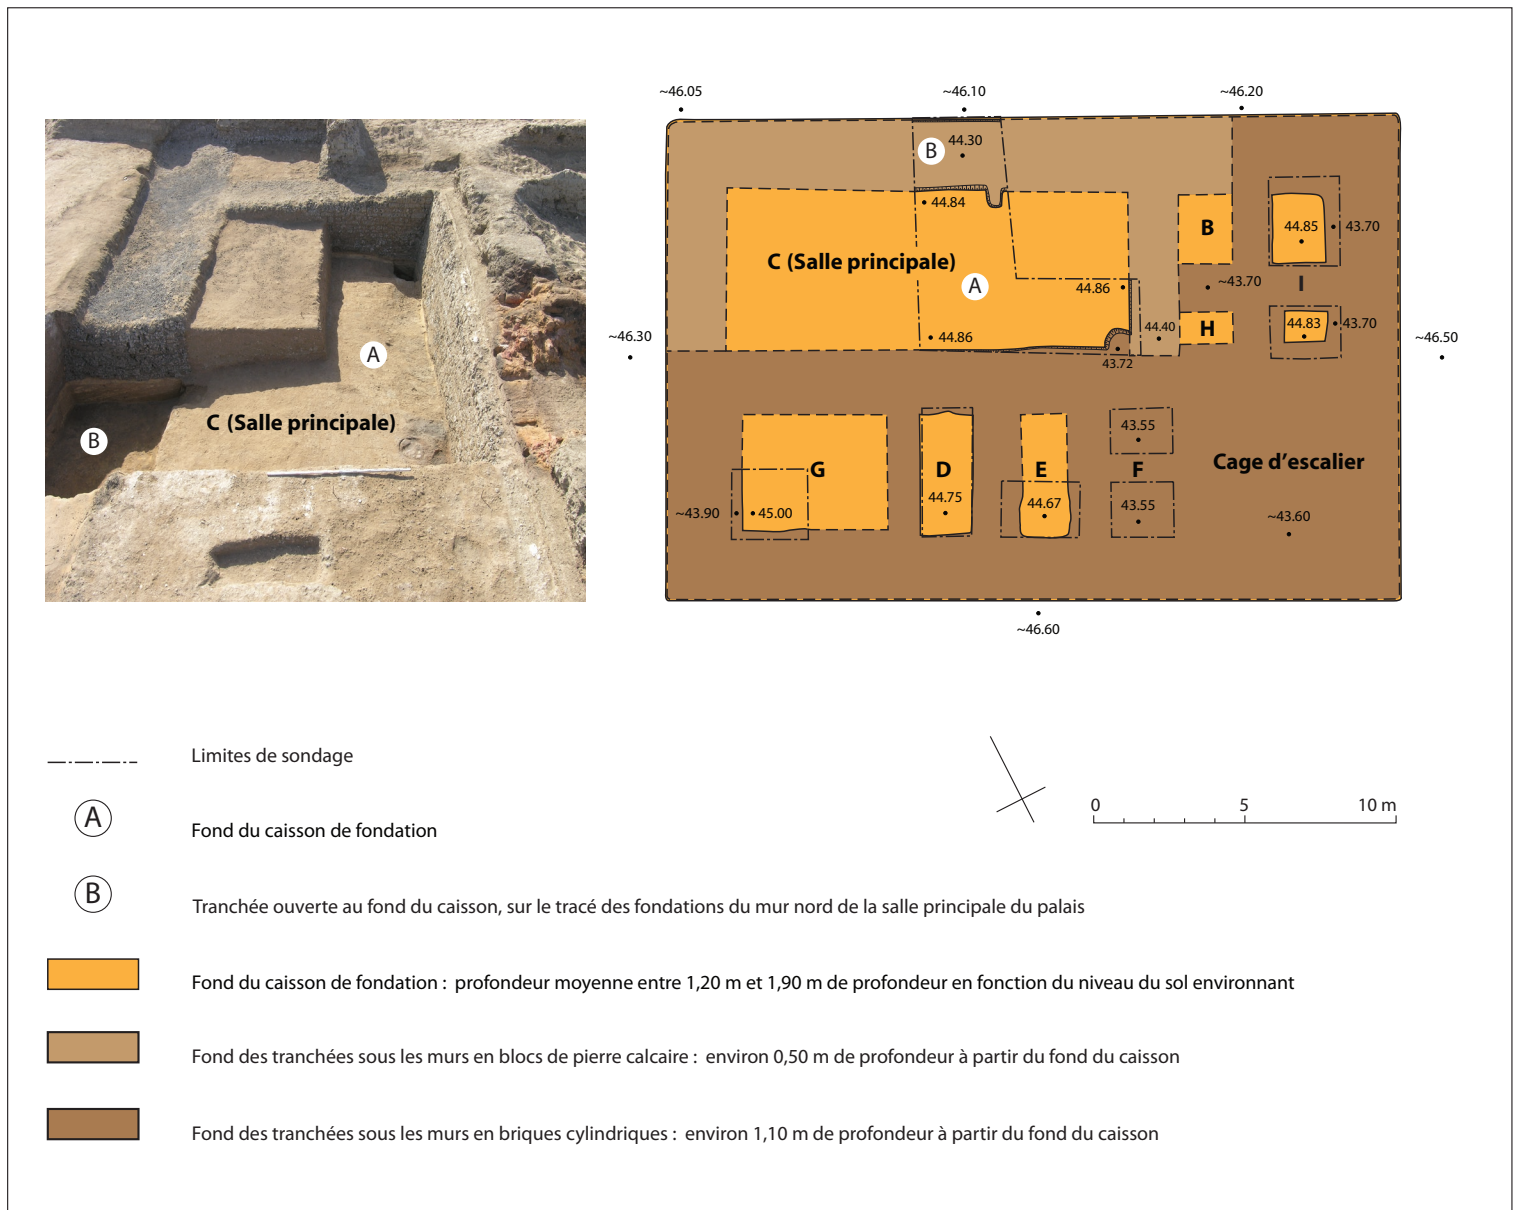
Fondations du palais : caisson préparatoire sur l'emprise du bâtiment et tranchées profondes sur le tracé de fondation des murs
